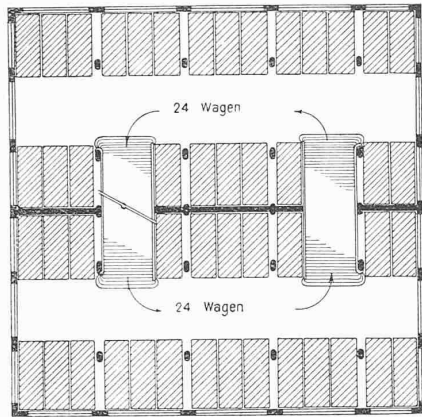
Grundrisse einer Garage für 48 Wagen pro Geschoss. — Masstab 1: 500.
